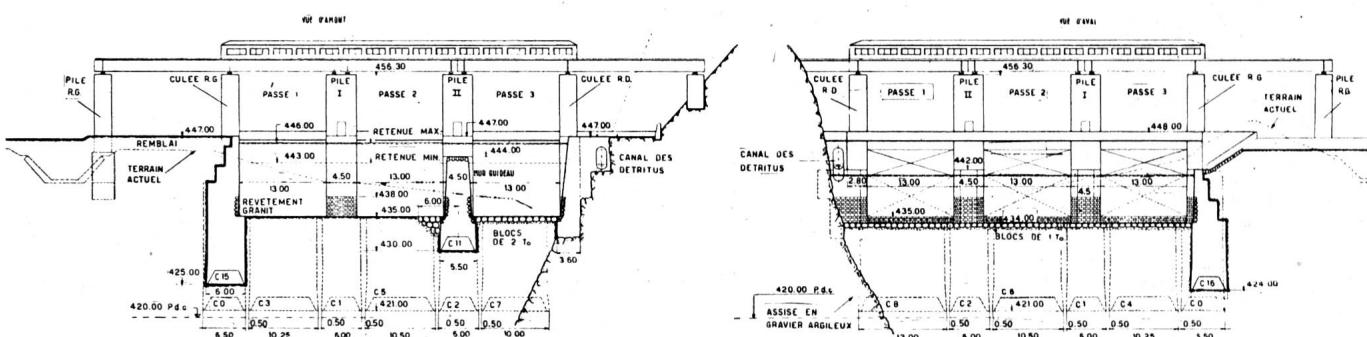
Barrage et prise d'eau, coupes transversales. Echelle 1:1200.
